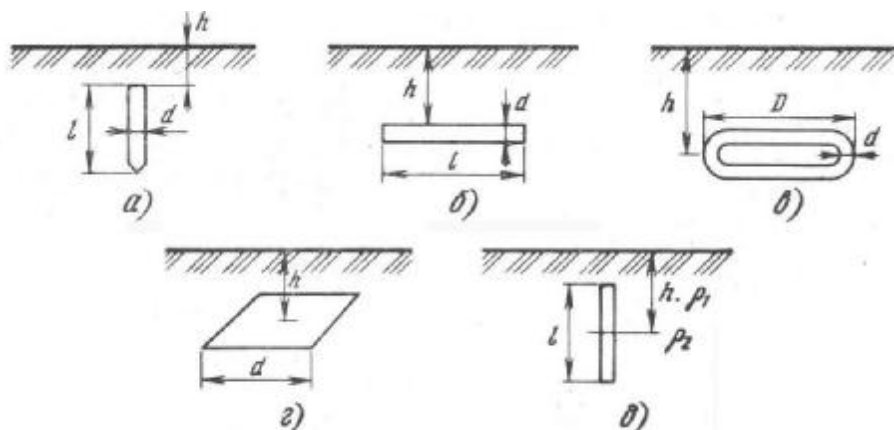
Конструкции заземлителей: а — вертикальный; б — горизонтальный; в — кольцевой; г — пластинчатый; д — глубинный.
